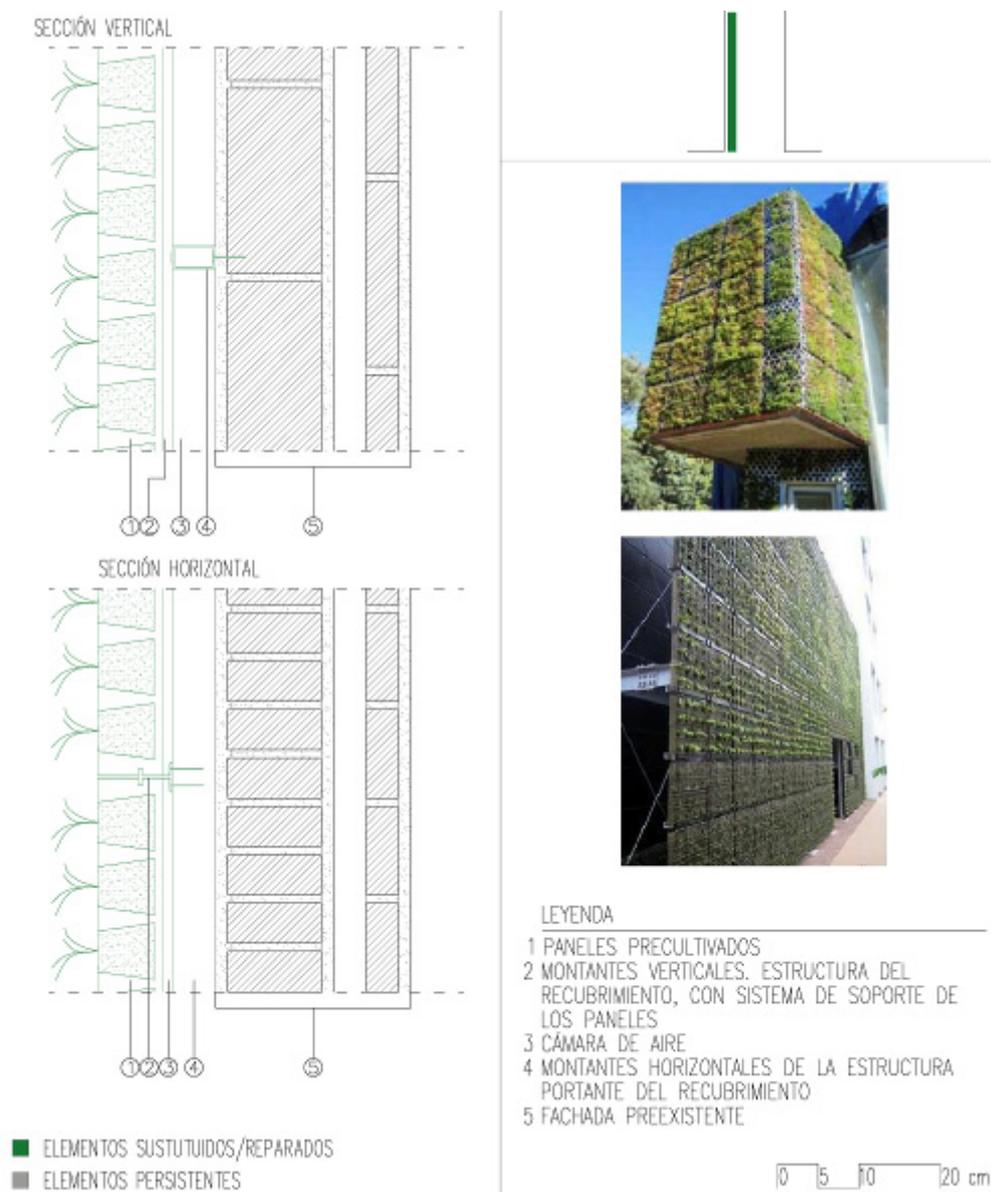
Paneles precultivados. Fuente: elaboración propia.
